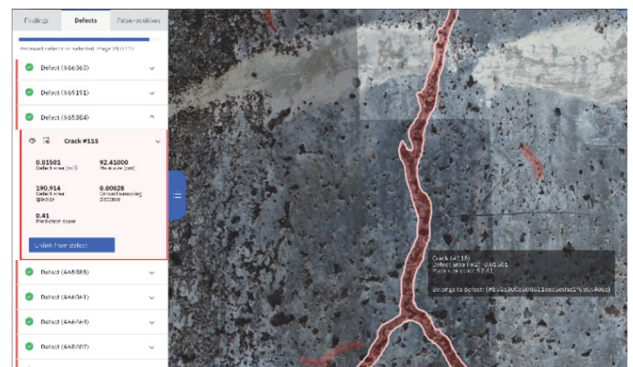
損傷箇所の注釈及びフィルタリングイメージ
